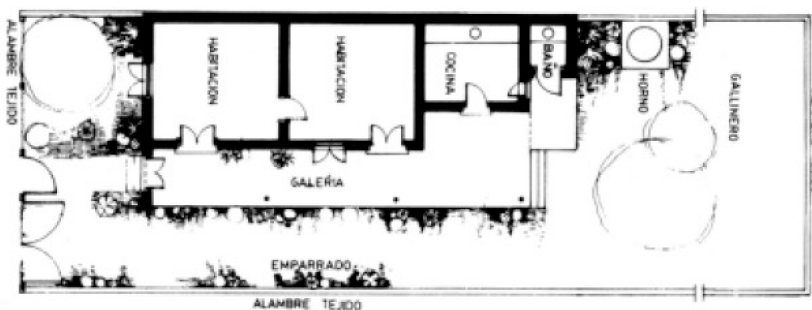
Planimetría de “la casa chorizo”. Carli 1980
